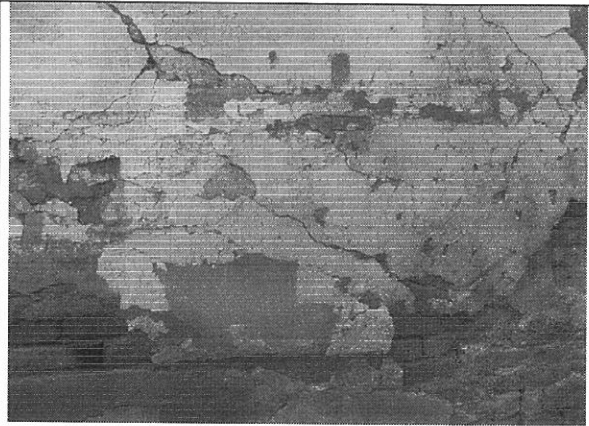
Agrietamientos en muro de la construcción interior
